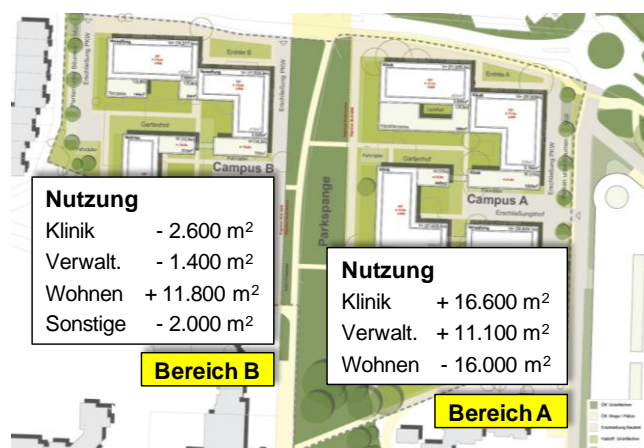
Flächenbilanz für die bestehenden und geplanten Nutzungen am „Neuenhofer Weg“ (B-Plan 977)
